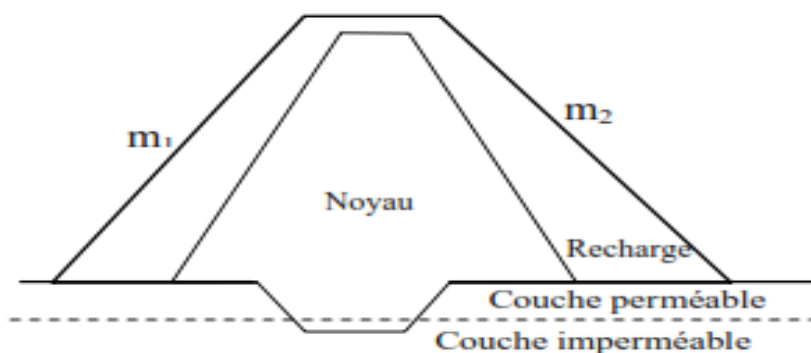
Coupe transversale de la digue avec la clé d'ancrage
